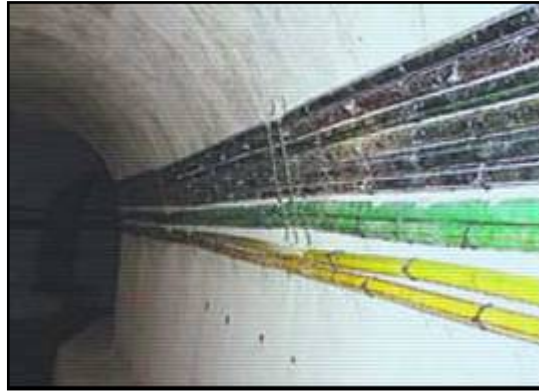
Canalización existente en red de alcantarillado (Fuente: www.clabsa.es)
